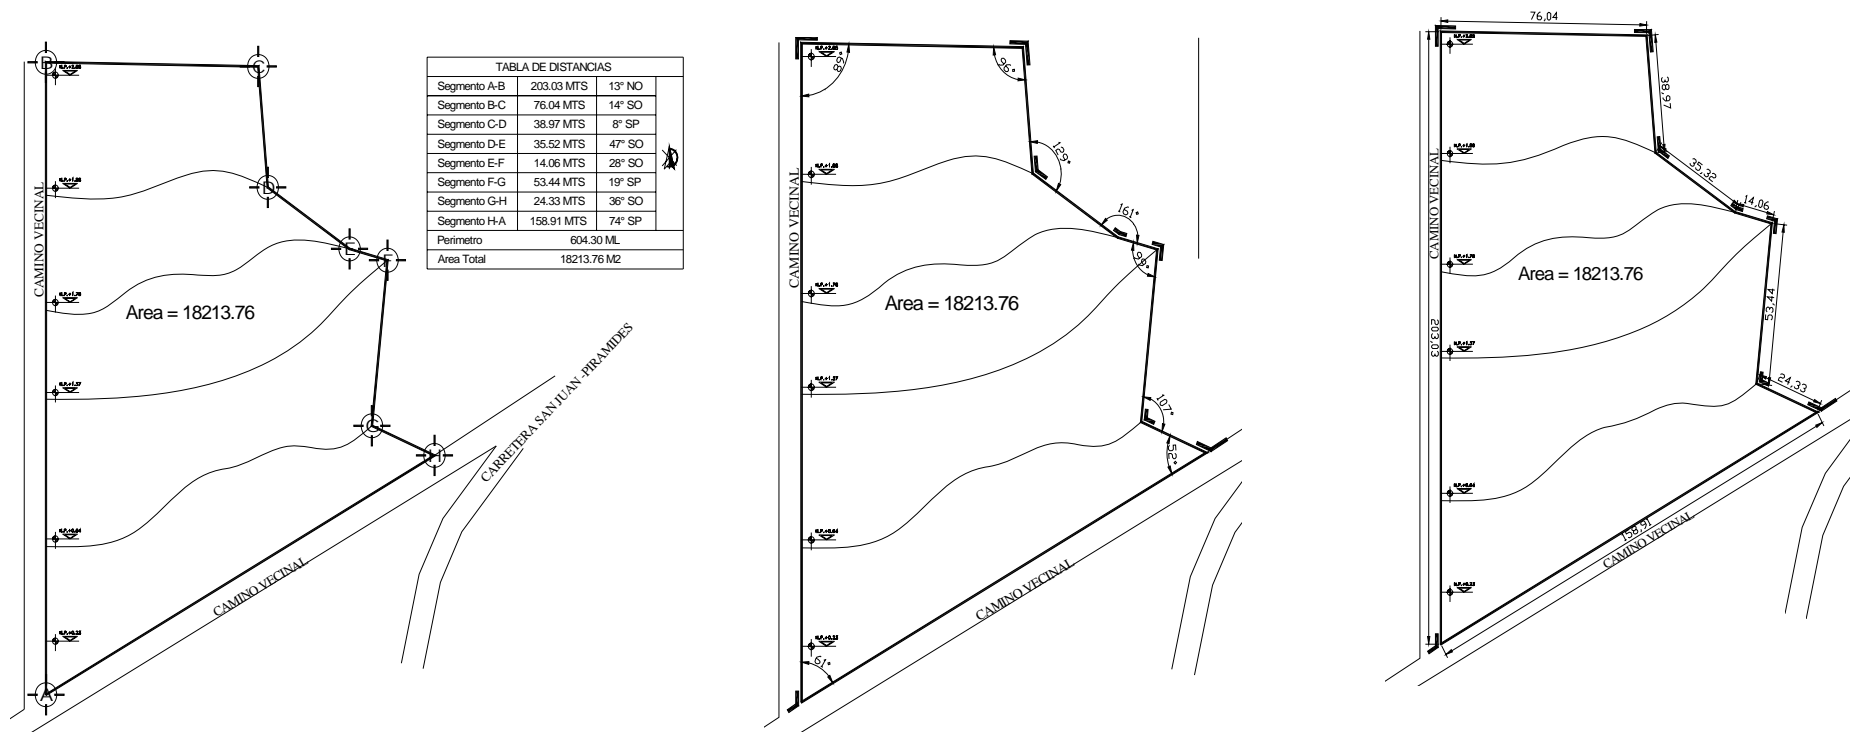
Planos de Terreno con Cotas y Niveles Generales.
